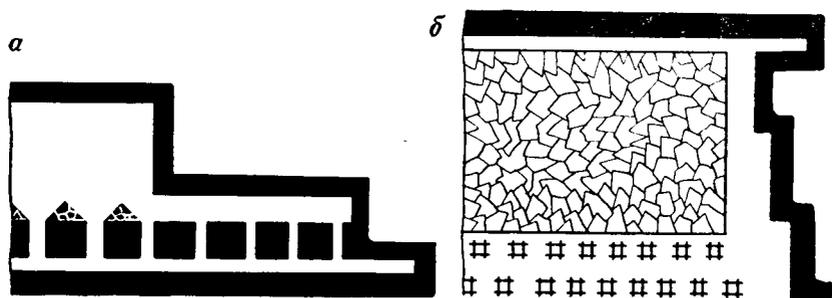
Сопряжения откаточного и вентиляционного штреков с лавой на крутых пластах:
